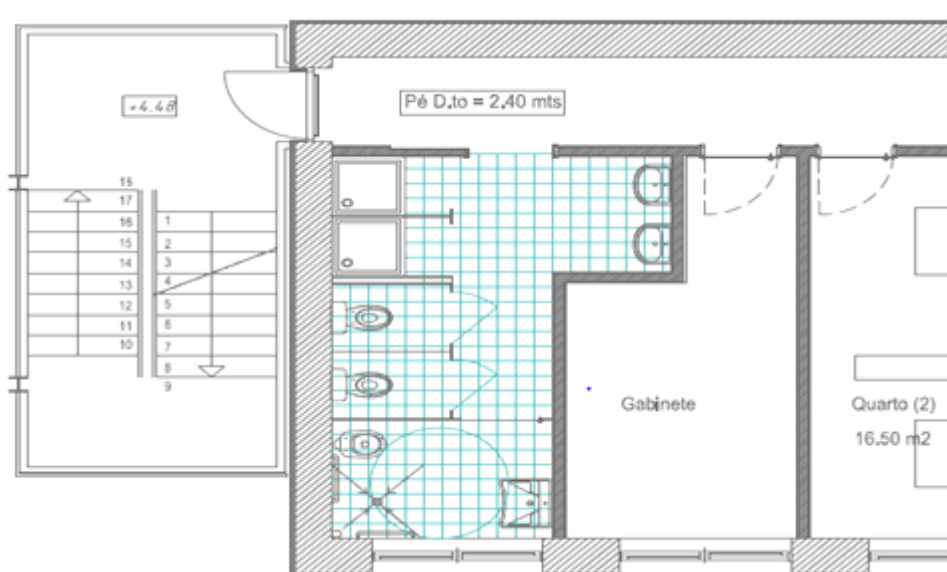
Alteração Arquitetura - Instalação Sanitária C24
